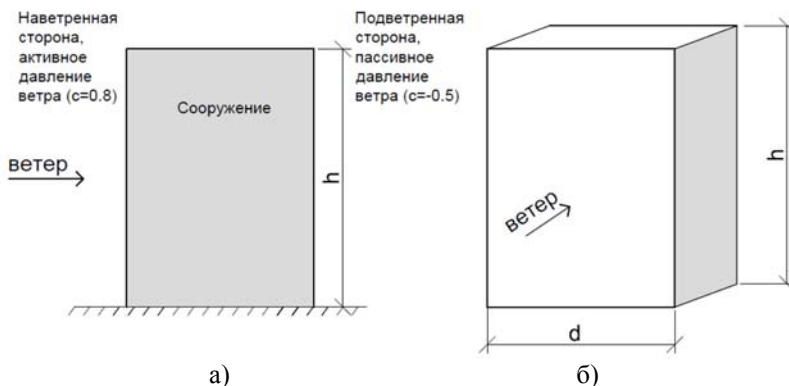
Схема к определению средней составляющей ветровой нагрузки  $\omega_m$ : а – аэродинамические коэффициенты для наветренной и подветренной сторон здания; б – направление действия ветровой нагрузки на фасад
